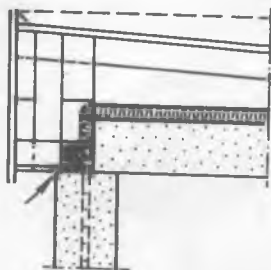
Соединение стены с верхним ячеистобетонным перекрытием для деревянной крыши со скатами внутрь. Крепление деревянной крыши может быть выполнено так, как показано на рис.39.
